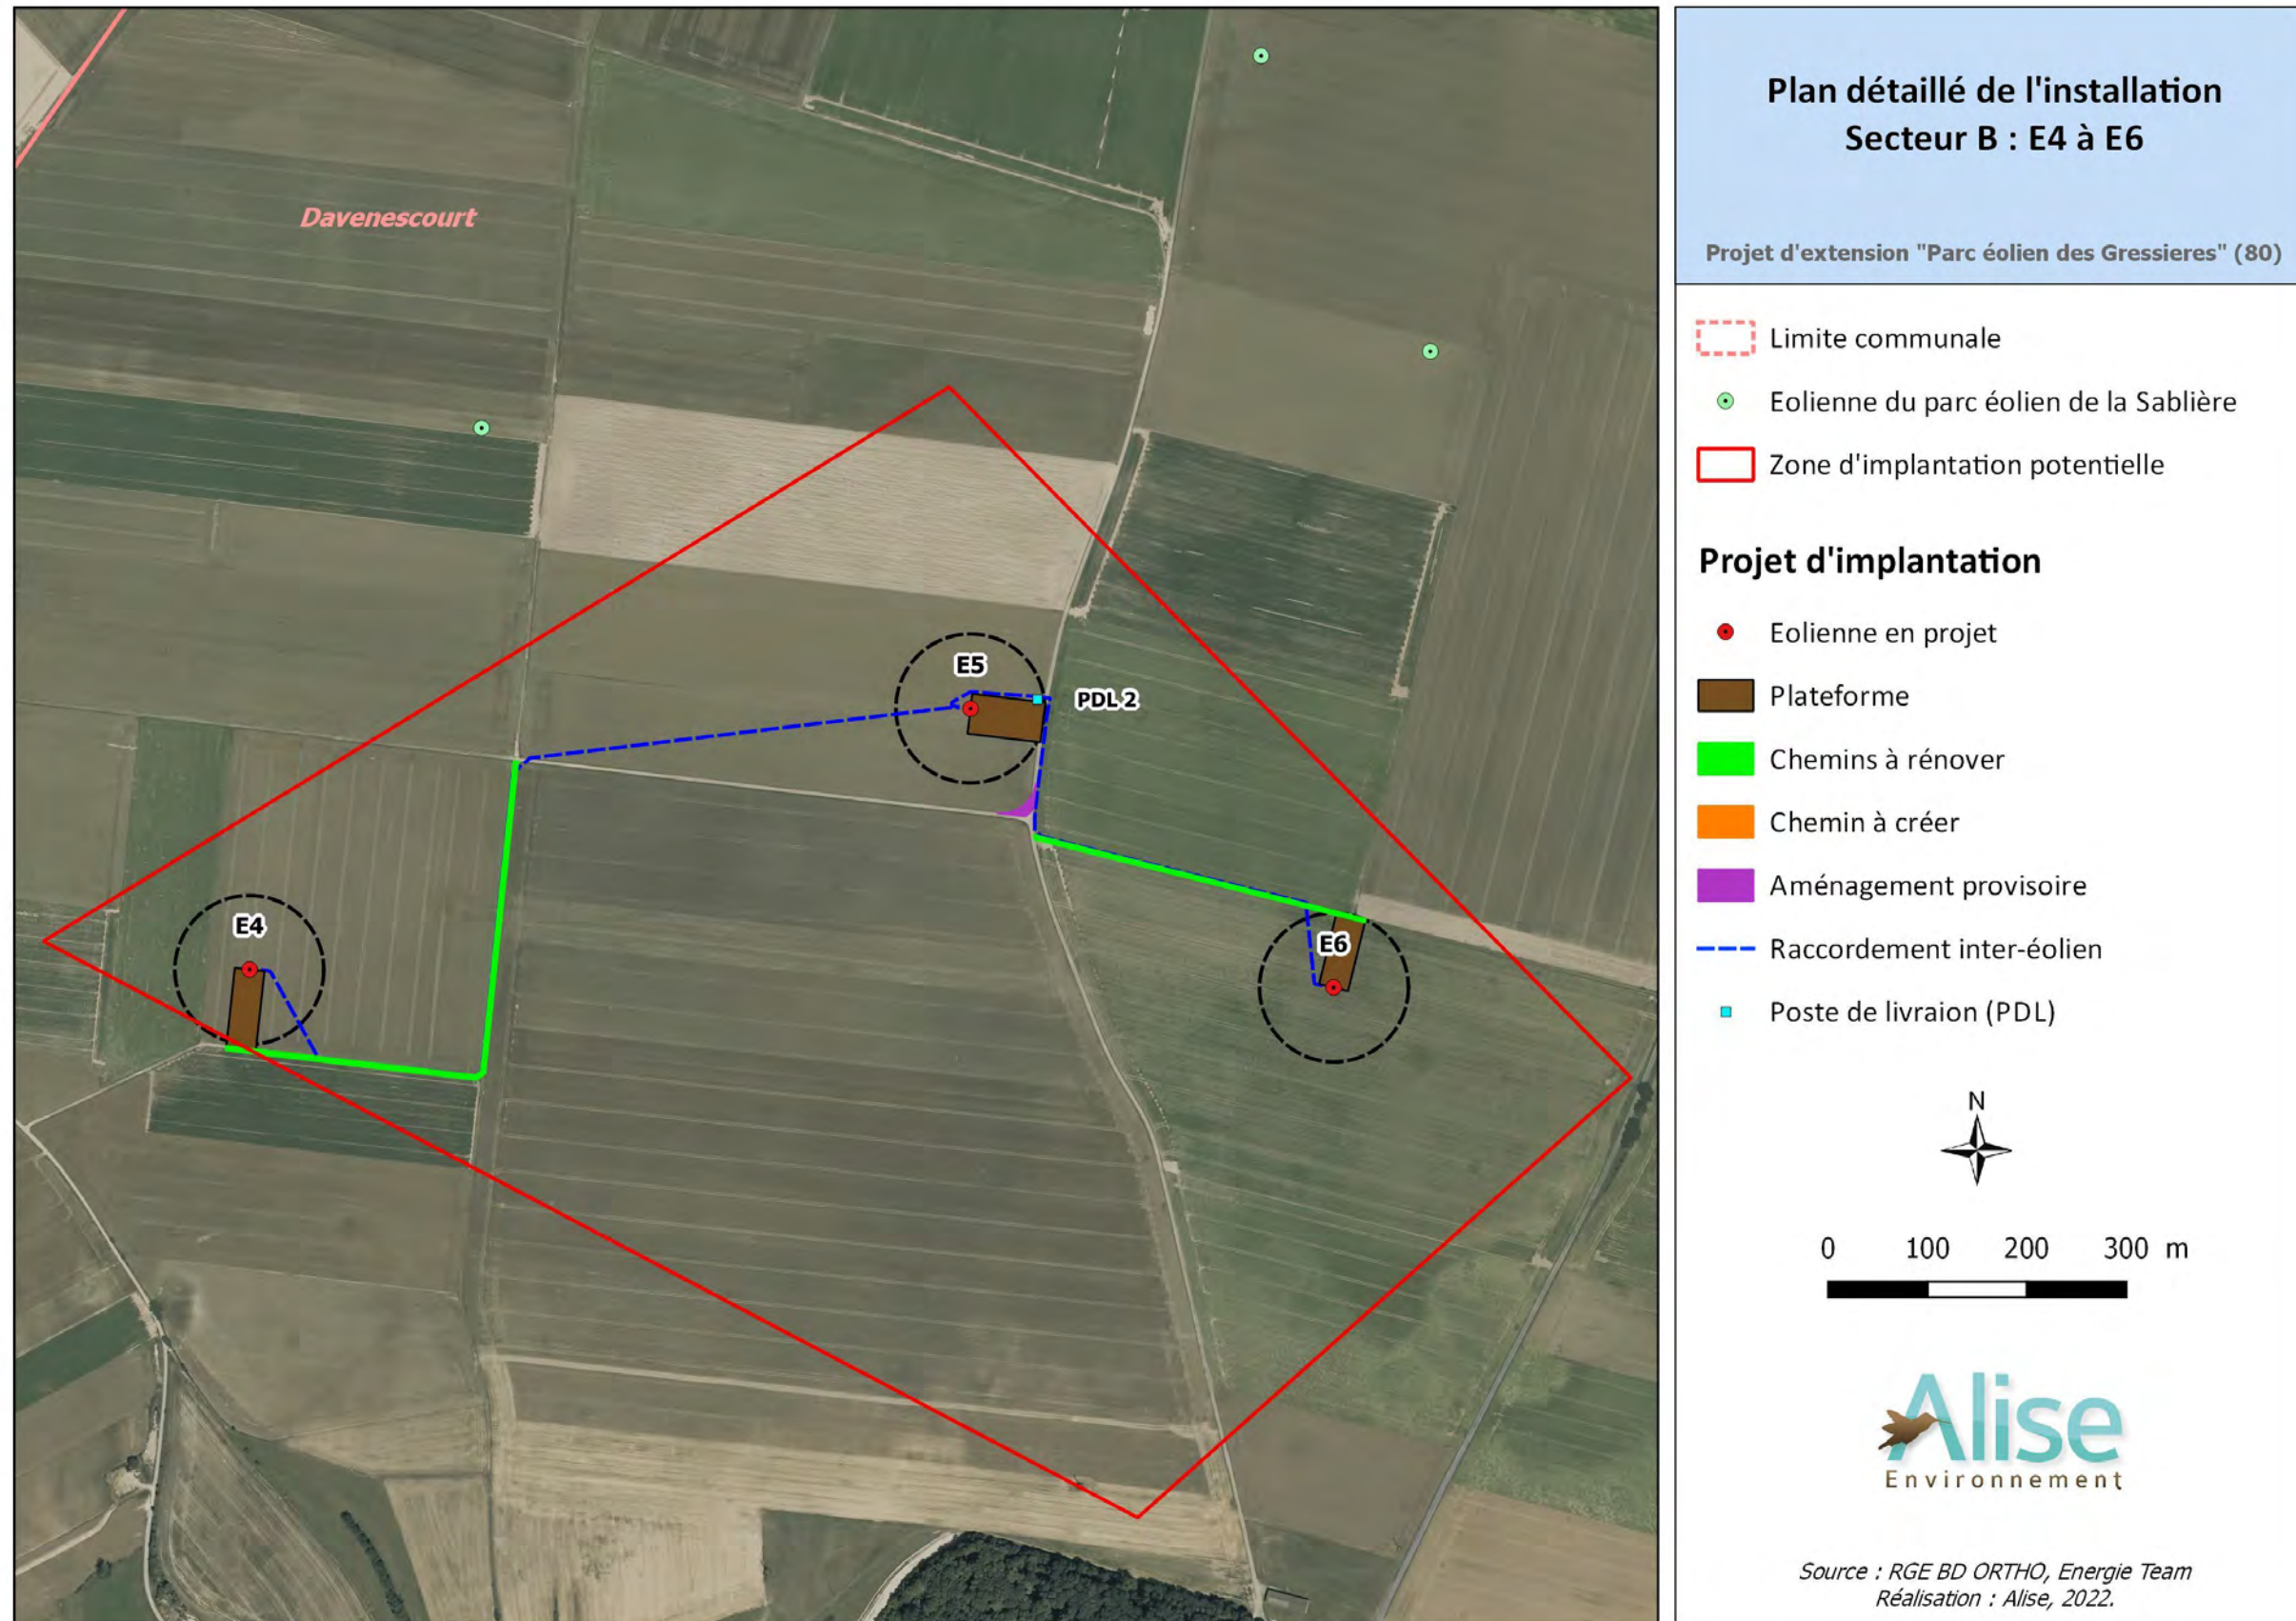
Plan détaillé de l'installation – Secteur B : E4 à E6
